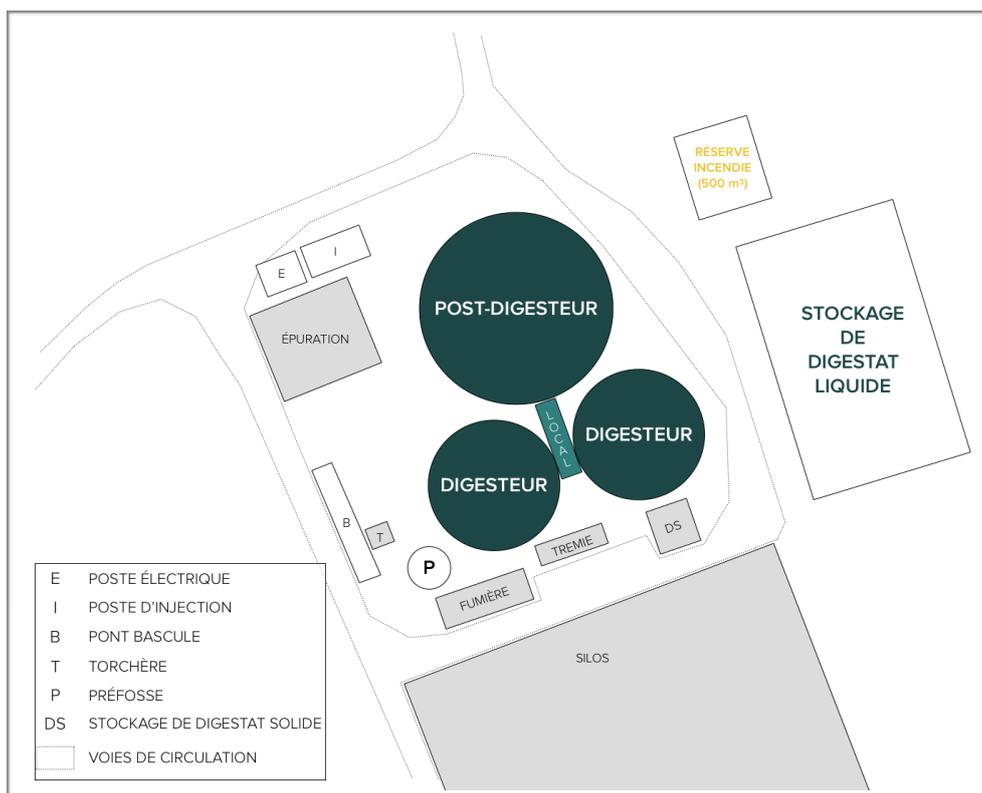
PLAN DU SITE D'EXPLOITATION DE LA SAS MÉTHACHRIST
